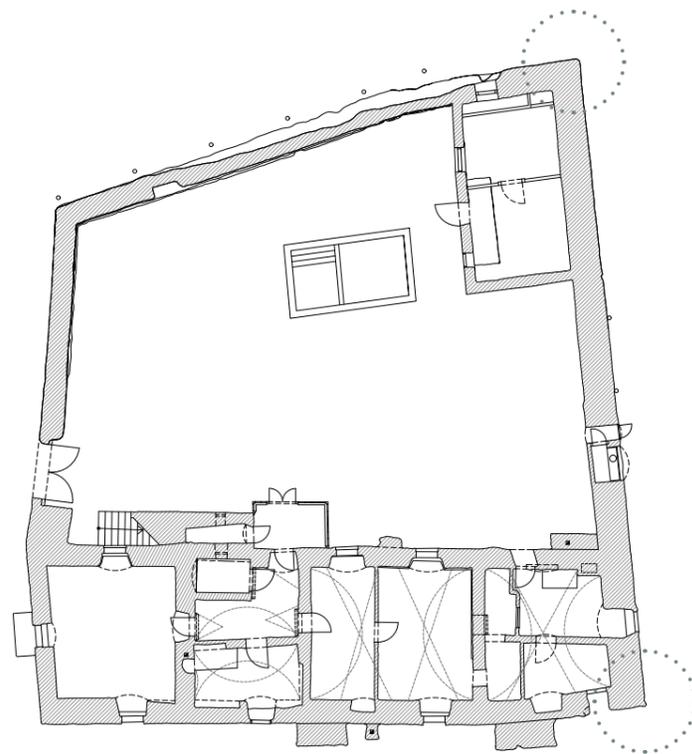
Lage Buckel- und Glattquader, Grundriss Erdgeschoß
